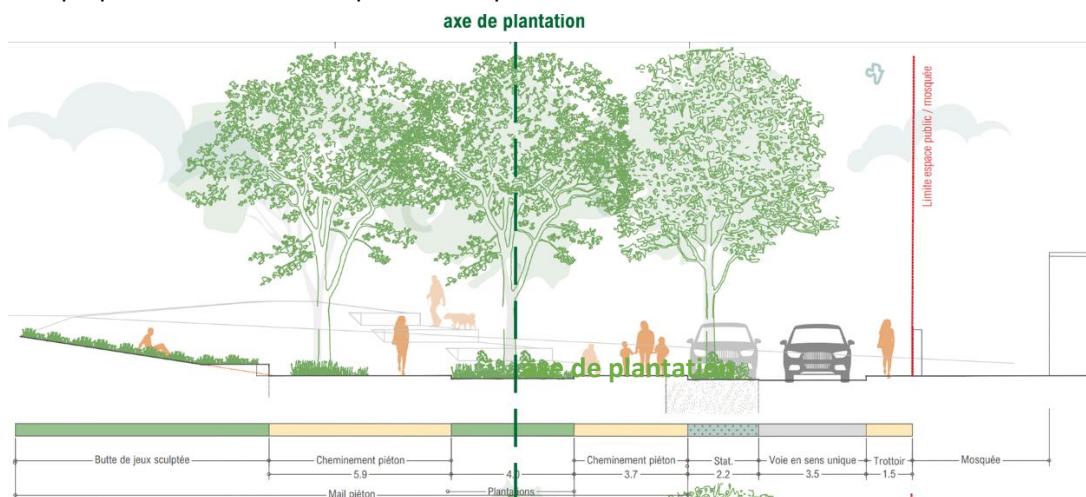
Plan de coupe au droit de l'allée des chênes (La Fabrique Urbaine, 06/2024)
